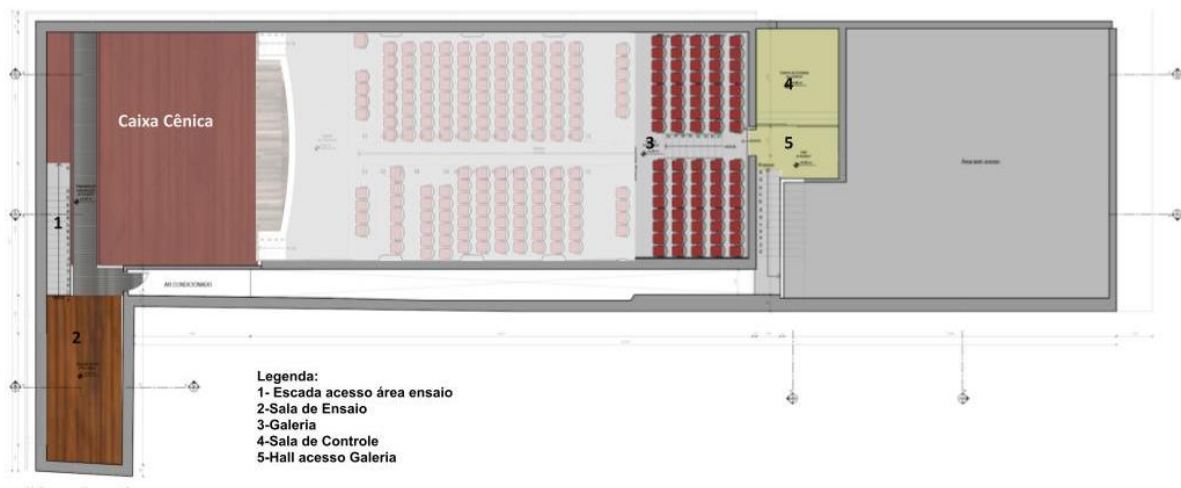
Proposta de Intervenção - Planta Baixa Térreo Cine teatro Neroly.
